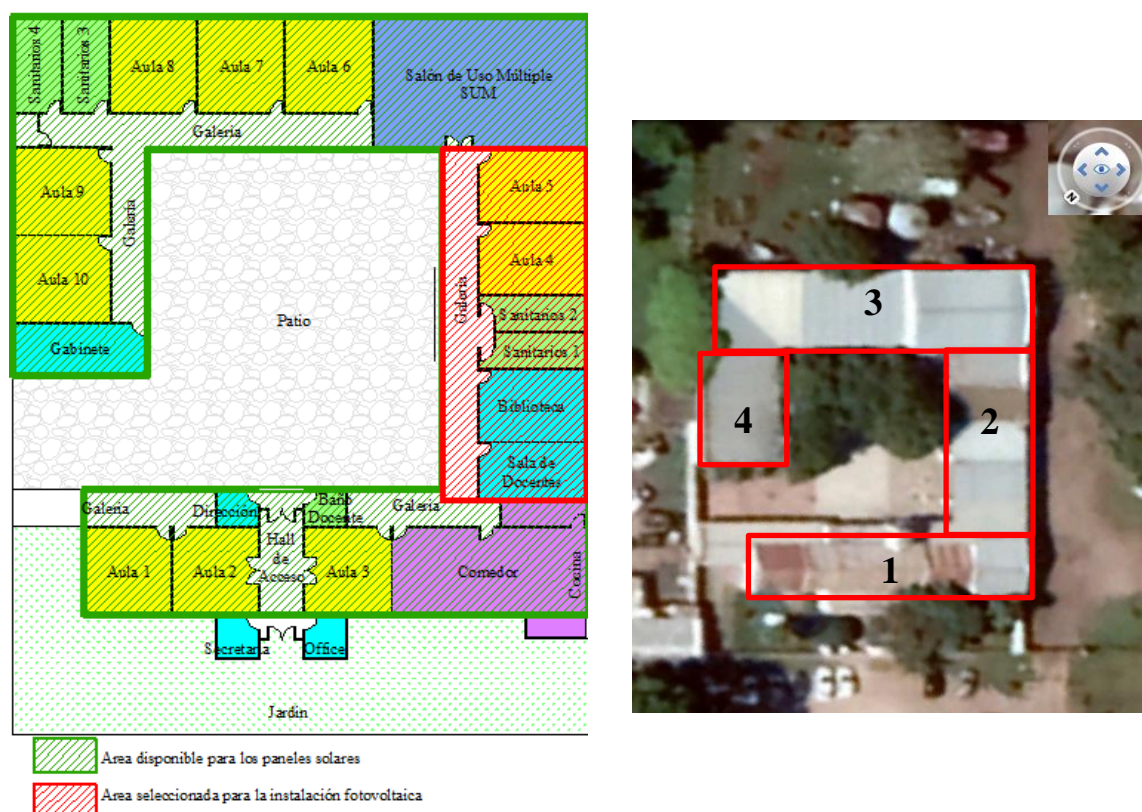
Zonas para posicionar la instalación fotovoltaica sobre el plano y en la imagen. Fuente: Elaboración propia.
